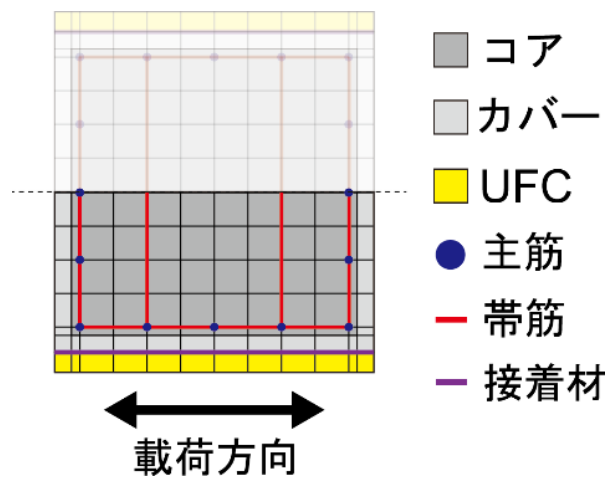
解析モデル断面詳細 (C-USJ-M)
